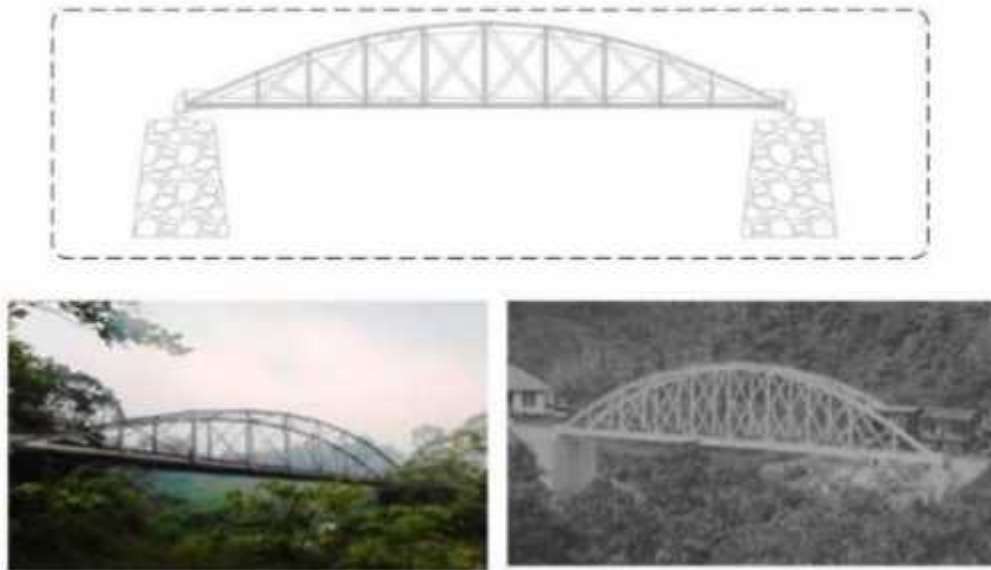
Jembatan Kereta Api Sungai Andok Kota Padang Panjang
